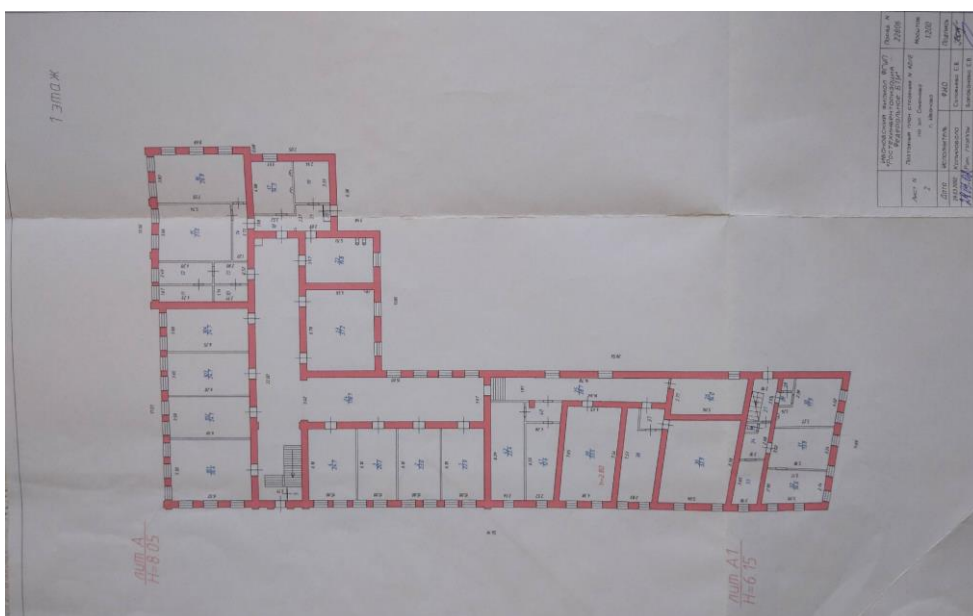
, 50. Планы 1 этажа здания № 42/2 по ул. Смирнова на 2002 г. и 2008 г.
